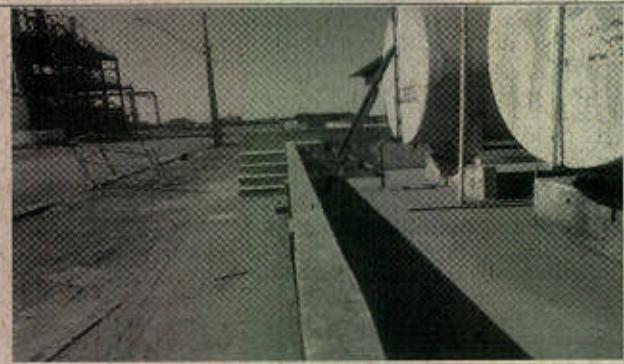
Ponto de abastecimento onde ocorrerá a ampliação
